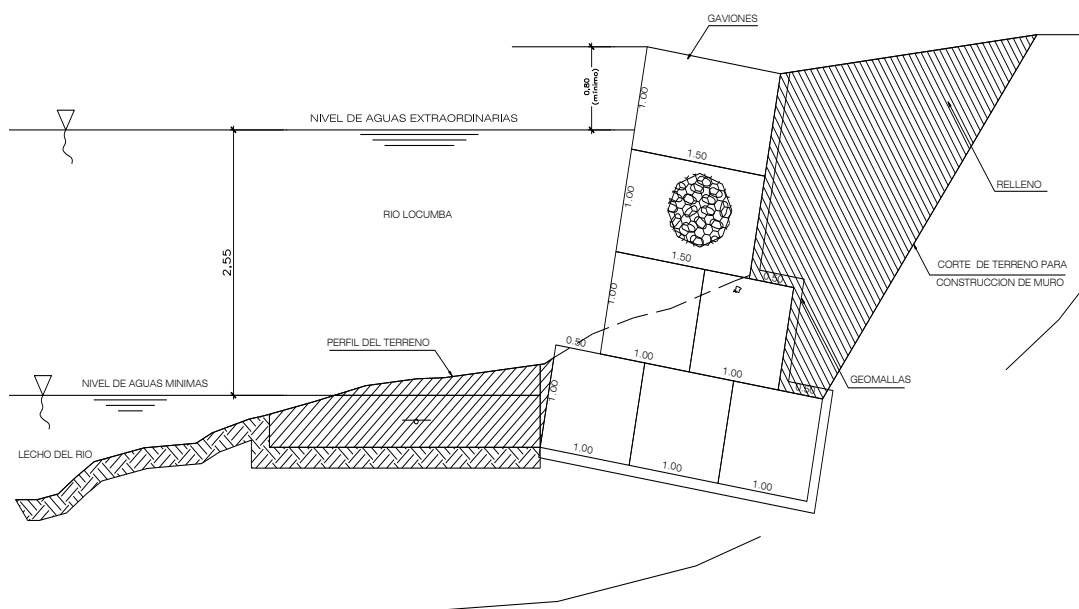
sección típica de muro gavión MG-1, donde se tiene una altura de 4 m. con una base de 3 m. Utilizado para proteger las zona de proyecto 1 y 2 (Carretera asfaltada y en servicio C.P. Mirave - Oconchay).
